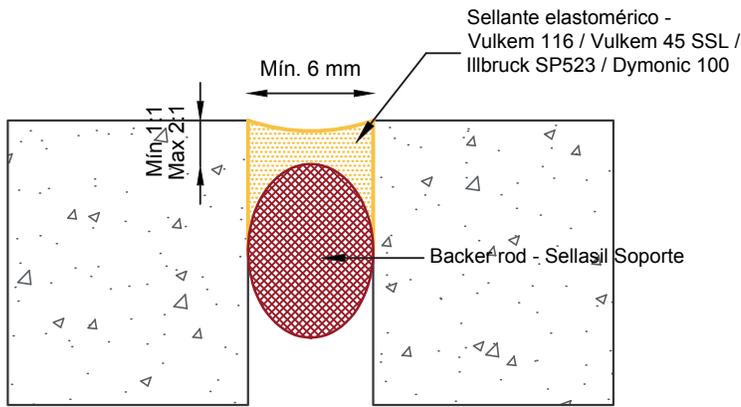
Detalle constructivo en Juntas de expansión. Con sello en campo o fluido
